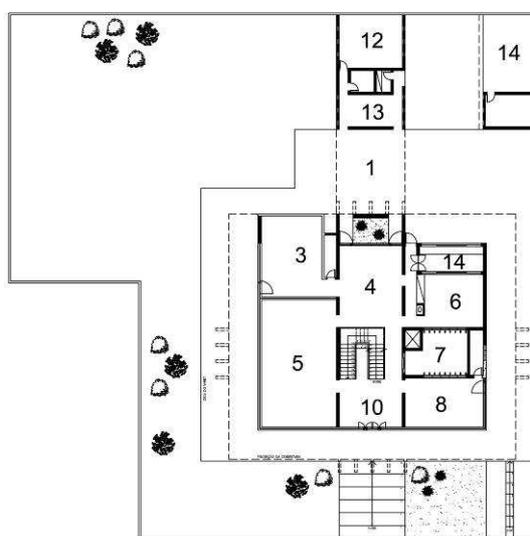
Pavimento térreo. Desenho: Rodrigo Queiroz
